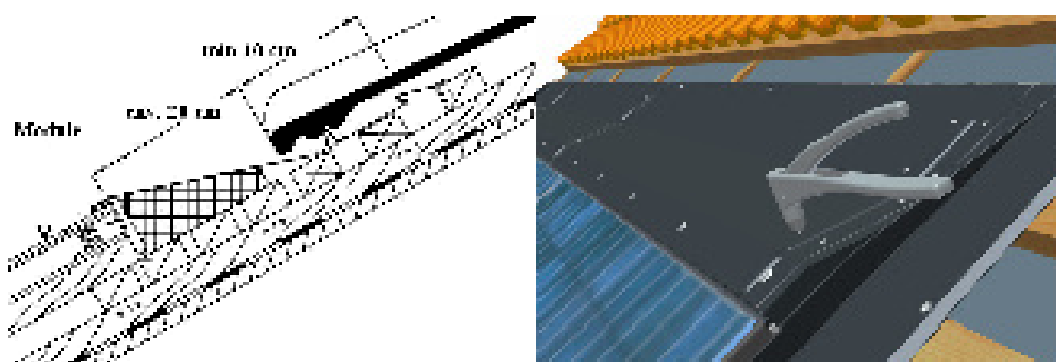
Schémas sur en haut d'installation PV (notice de montage des systèmes Energyroof et "Sol Montagesysteme25i" de S.E.N)
